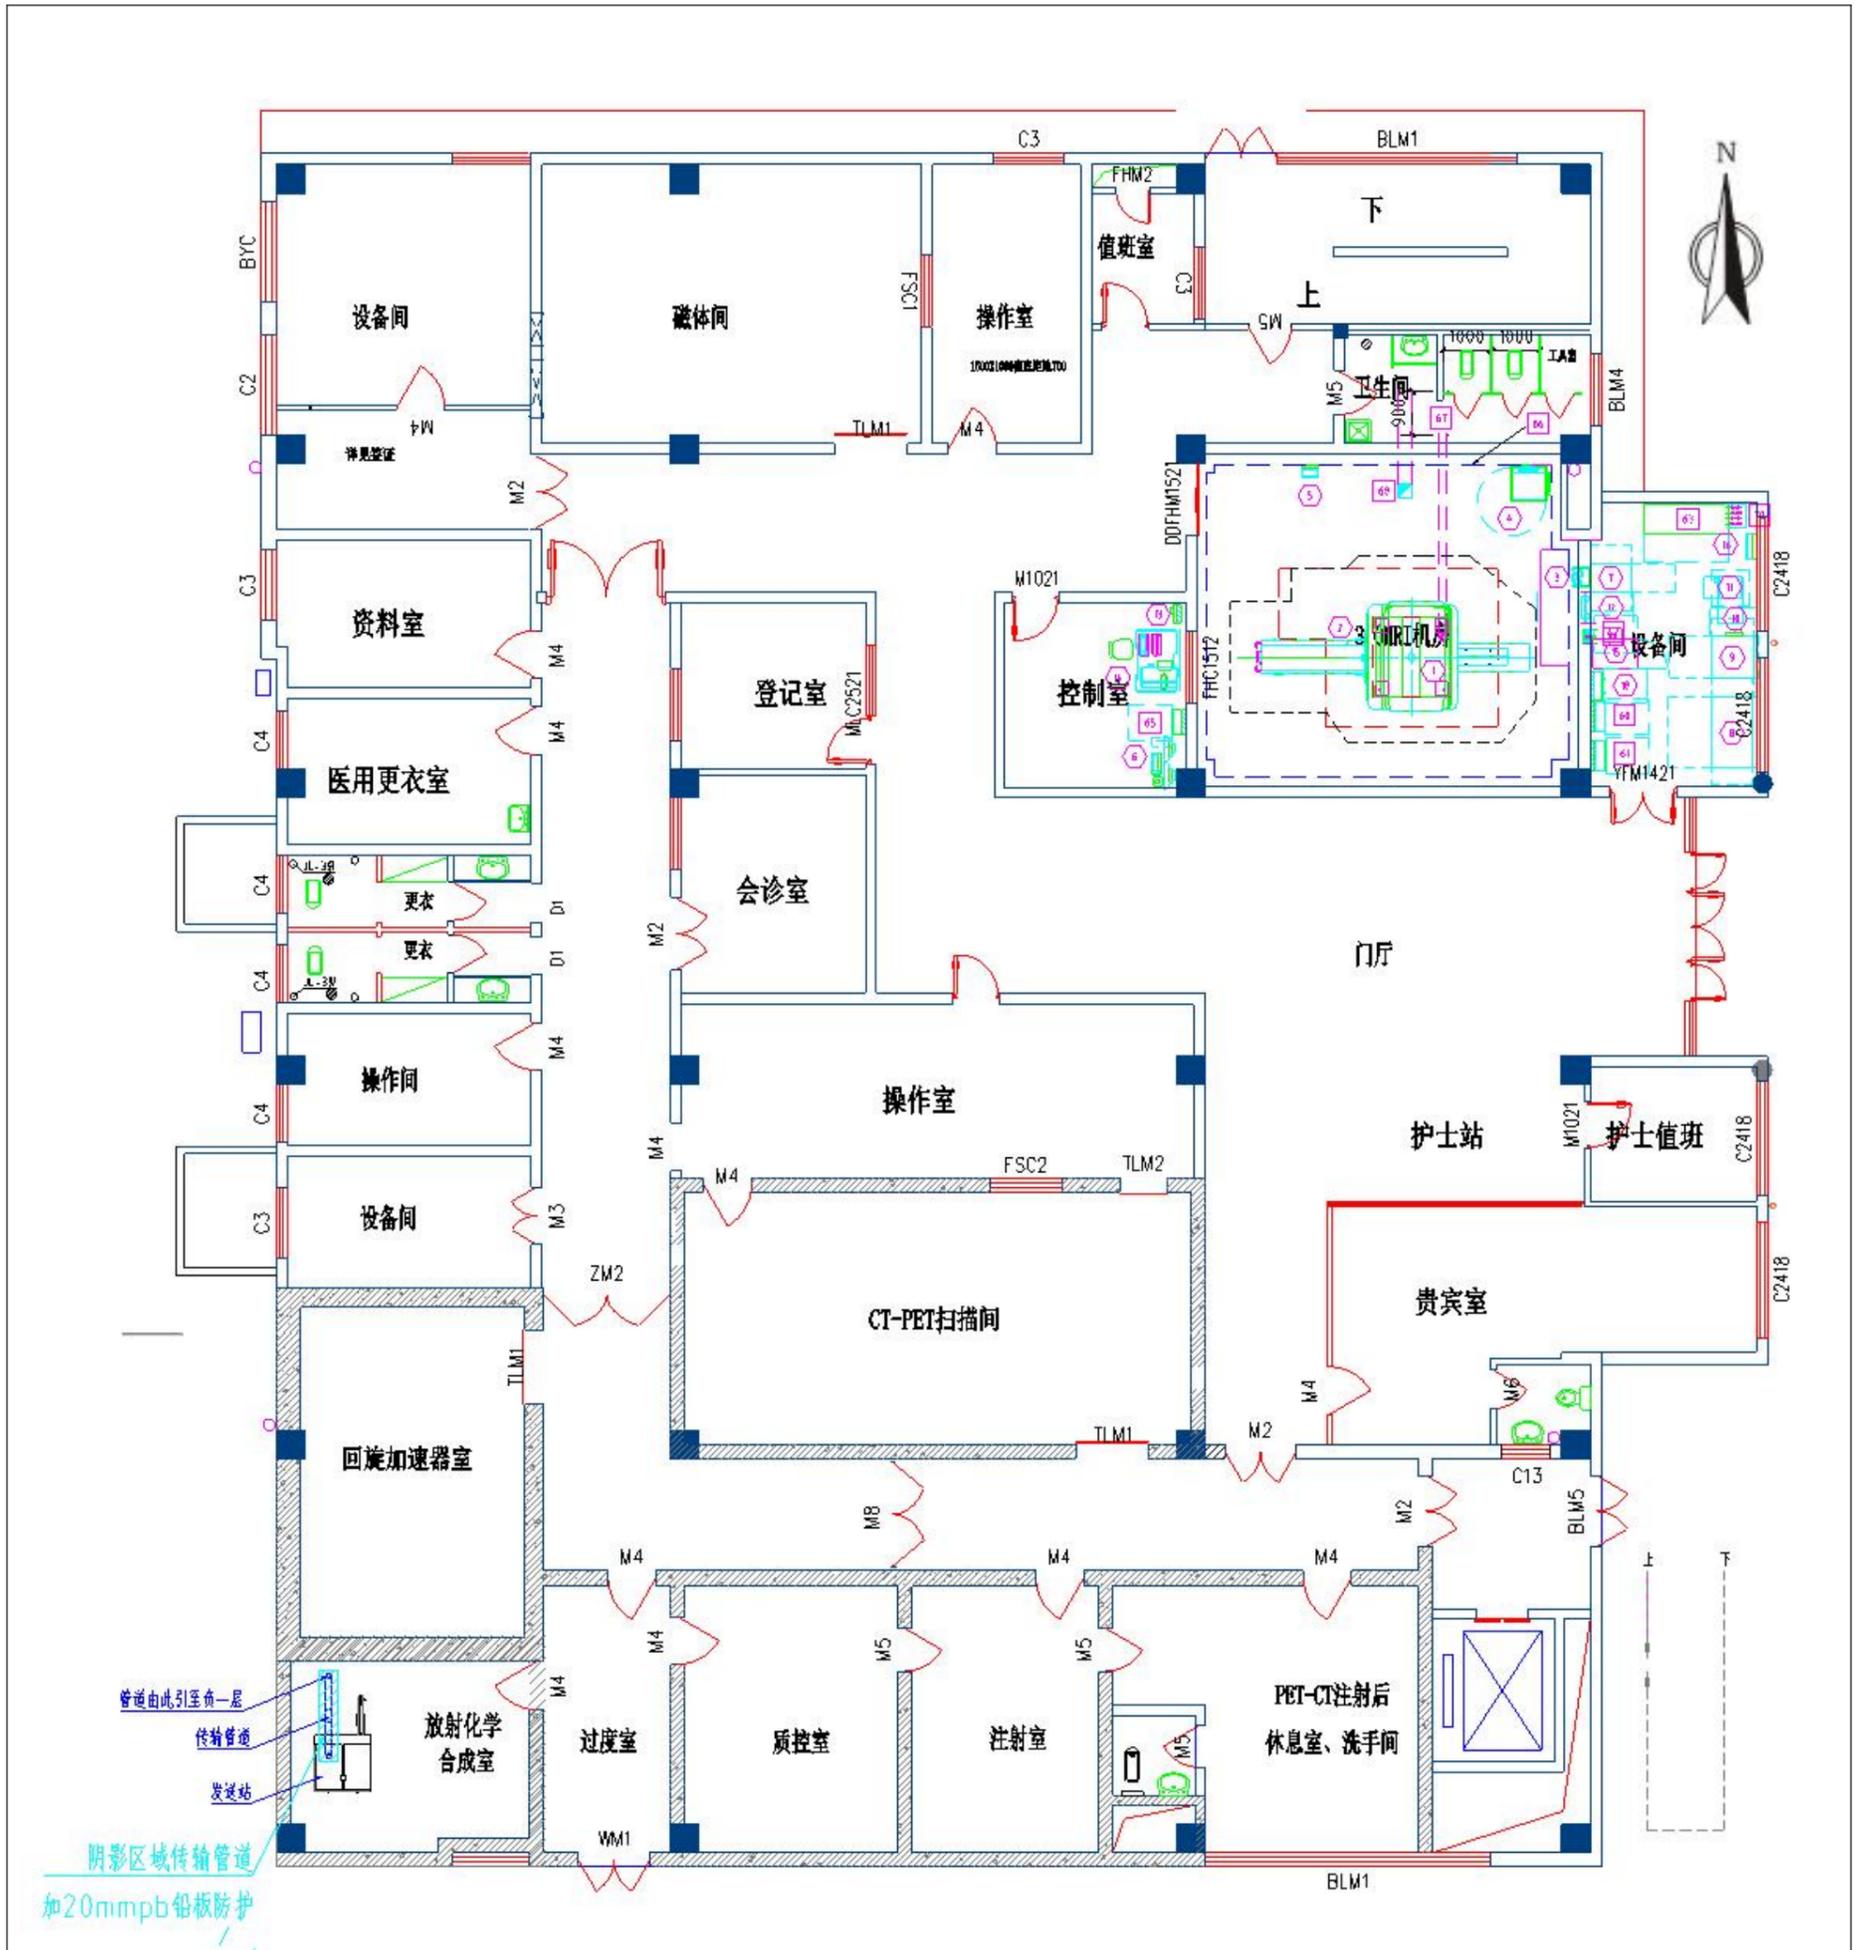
PET/CT 中心一层平面布置示意图 (项目上方)
